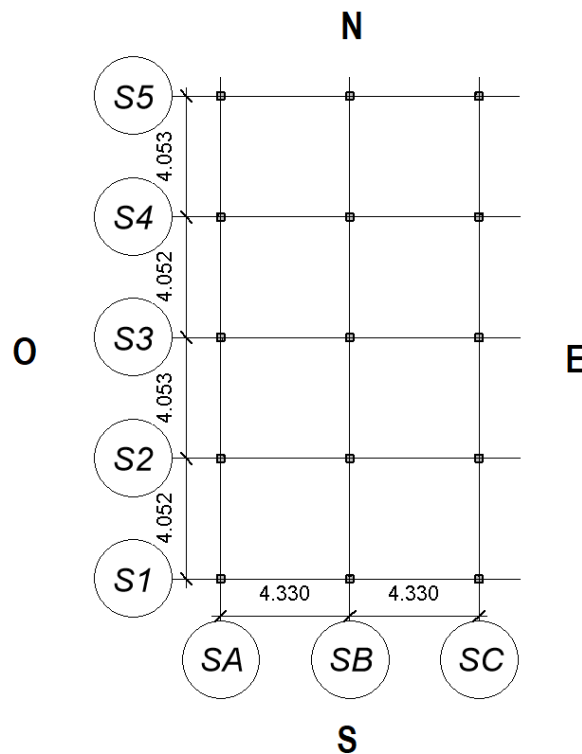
Vista en planta de los pilares del salón de actos y la distancia entre ellos
